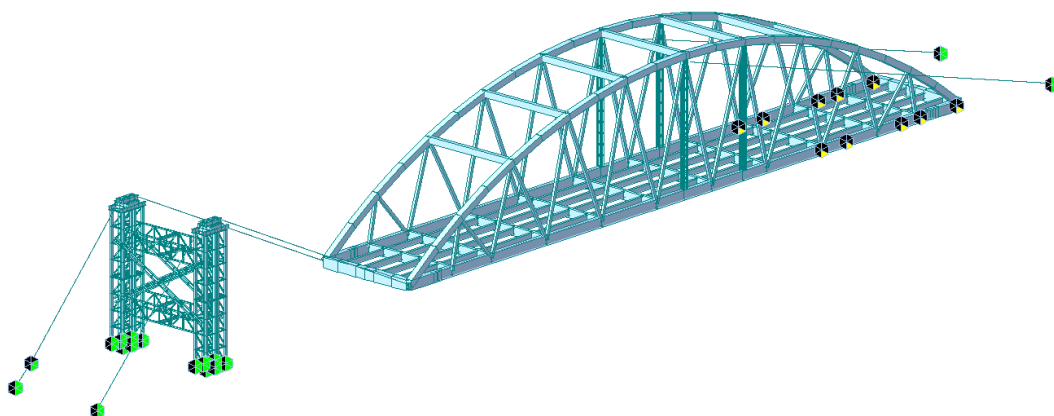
Modelo estructural del lanzamiento del puente Chupuro
